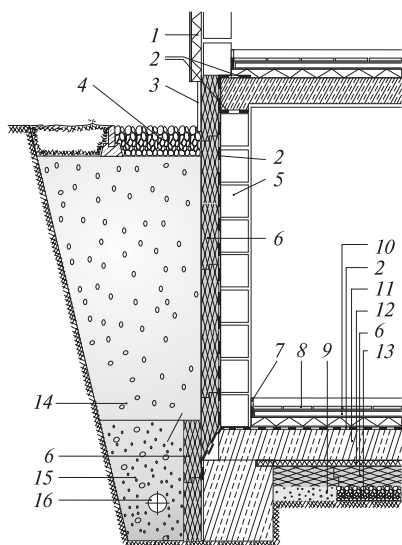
Теплоизоляция стен подвалов и фундаментов.
